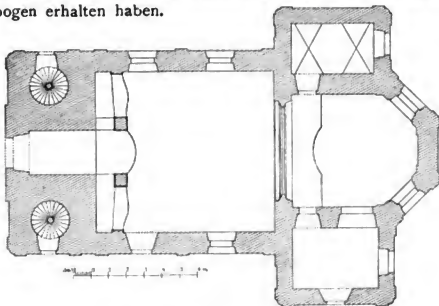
Wolduch, Grundriss der Kirche.
